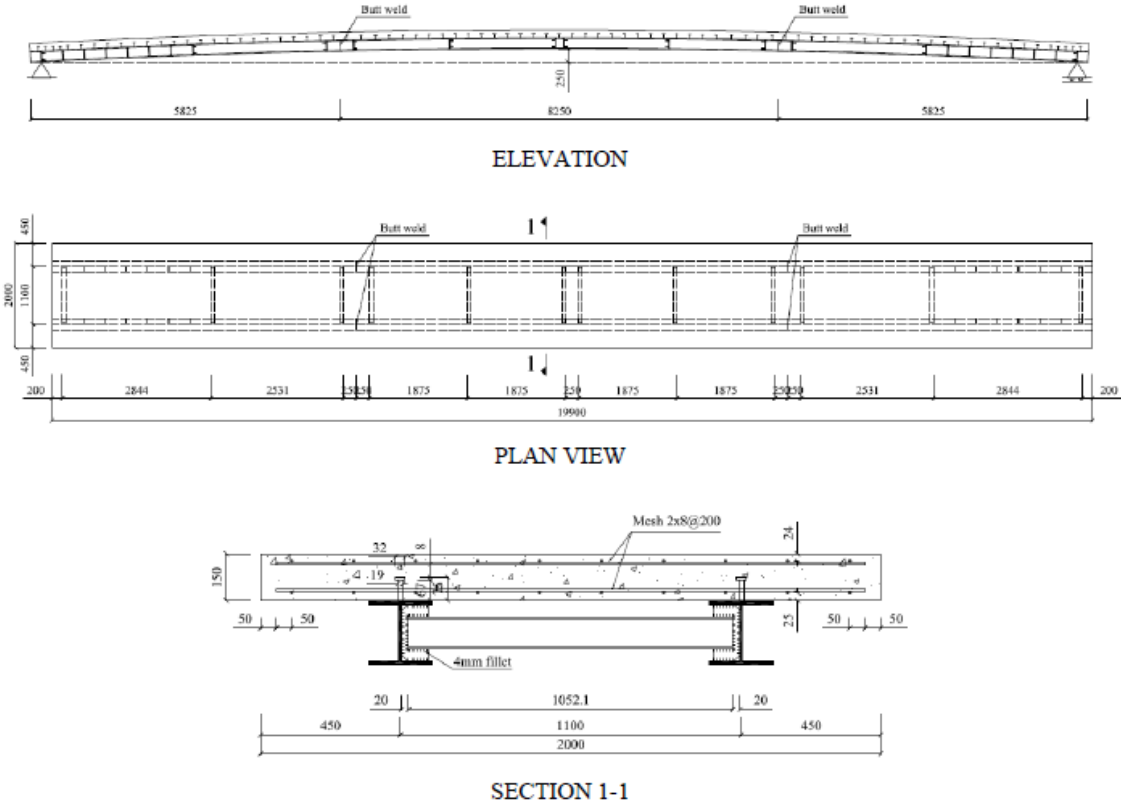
Vista de perfil, vista desde arriba y la sección de la pWB [59]
